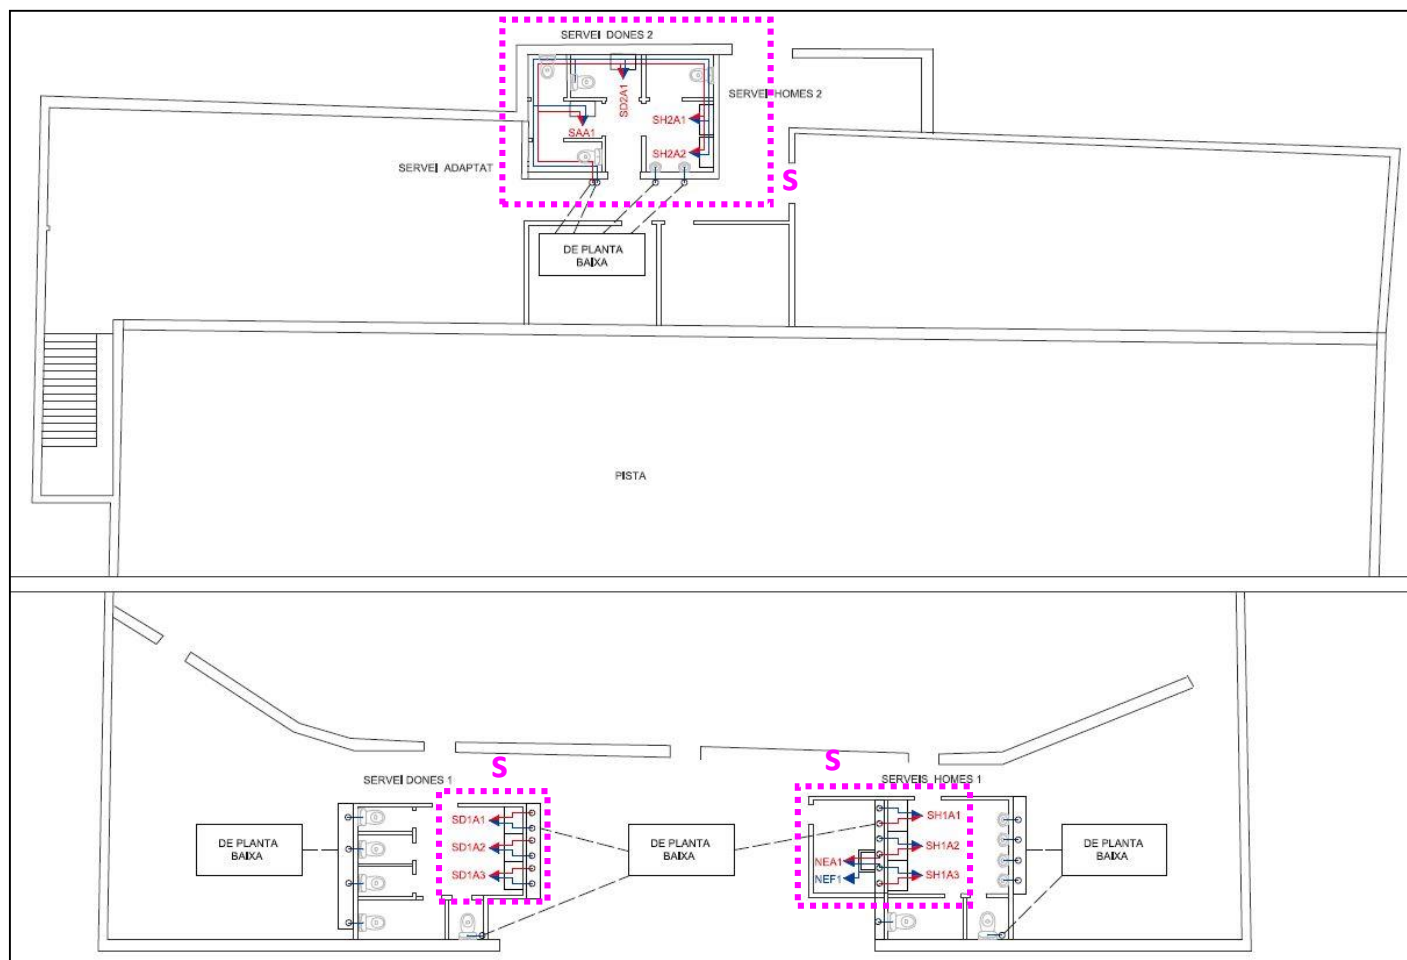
Detall traçat de canonades i aixetes dels serveis planta primera.
